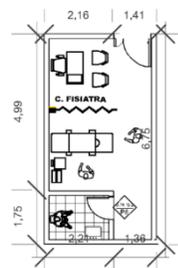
Plano de consultorio. Fuente elaborado por autor de tesis
